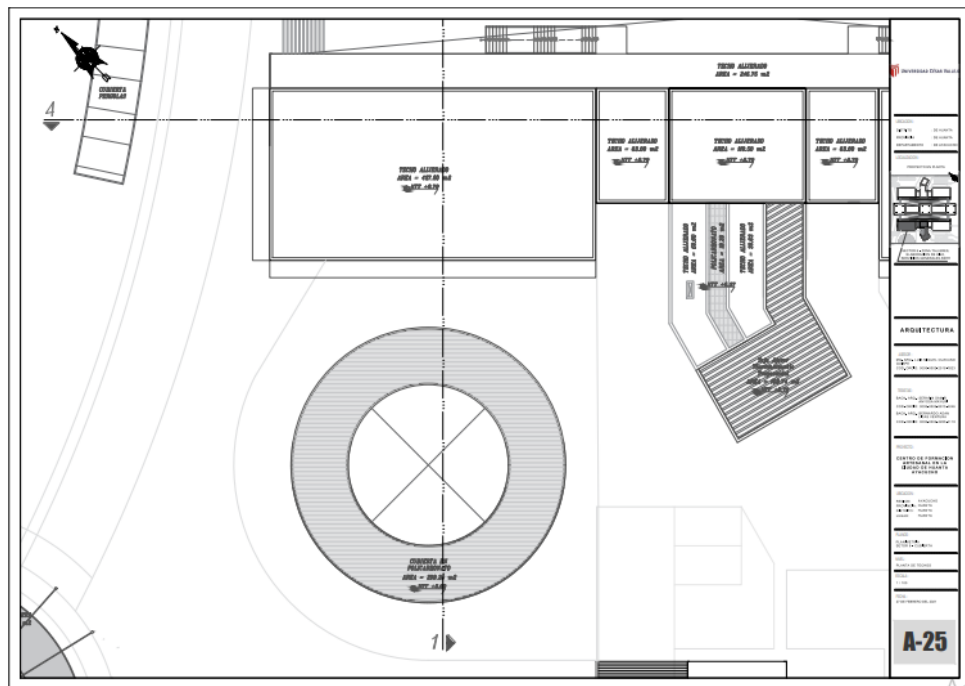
Planimetría de techos del sector 6. Escala 1/100.
